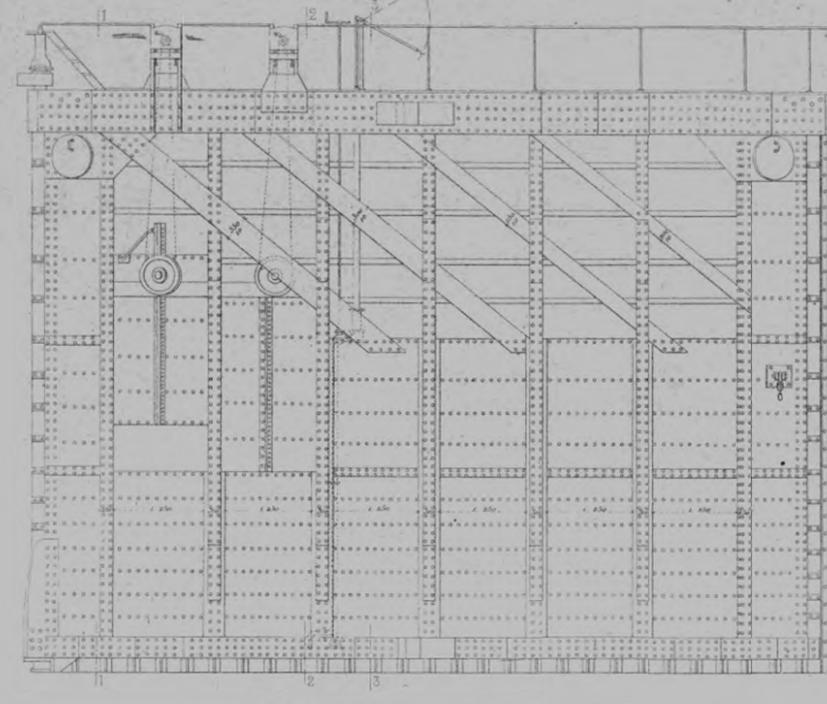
Plan de la porte d'êbe et de la porte valet, la passerelle enlevée.
